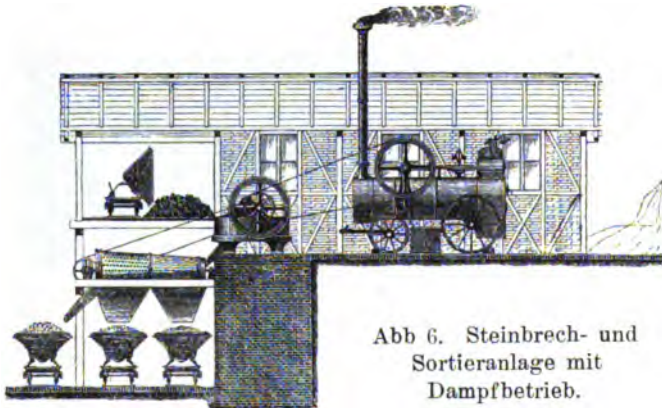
Steinbrech- und Sortieranlage mit Dampftrieb.
